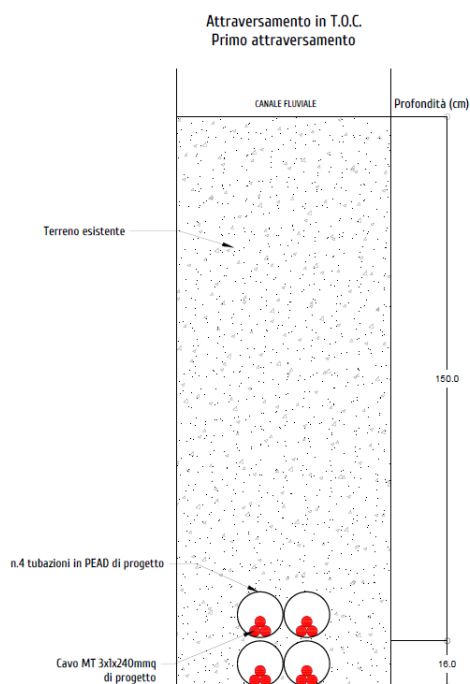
Sezione trasversale – Primo attraversamento in T.O.C.
